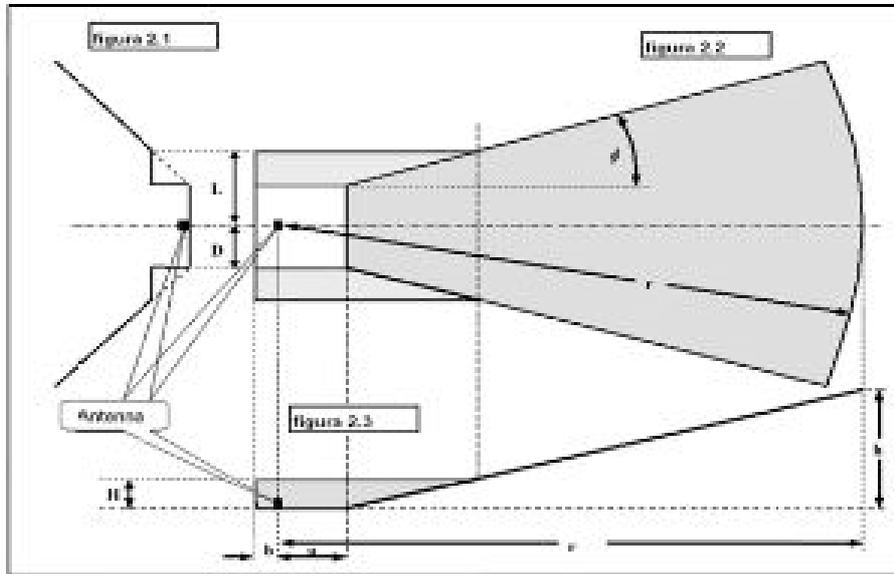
BRA per apparecchi direzionali (Elementi base per la costruzione delle Building Restricted Areas ENAV/ENAC)
